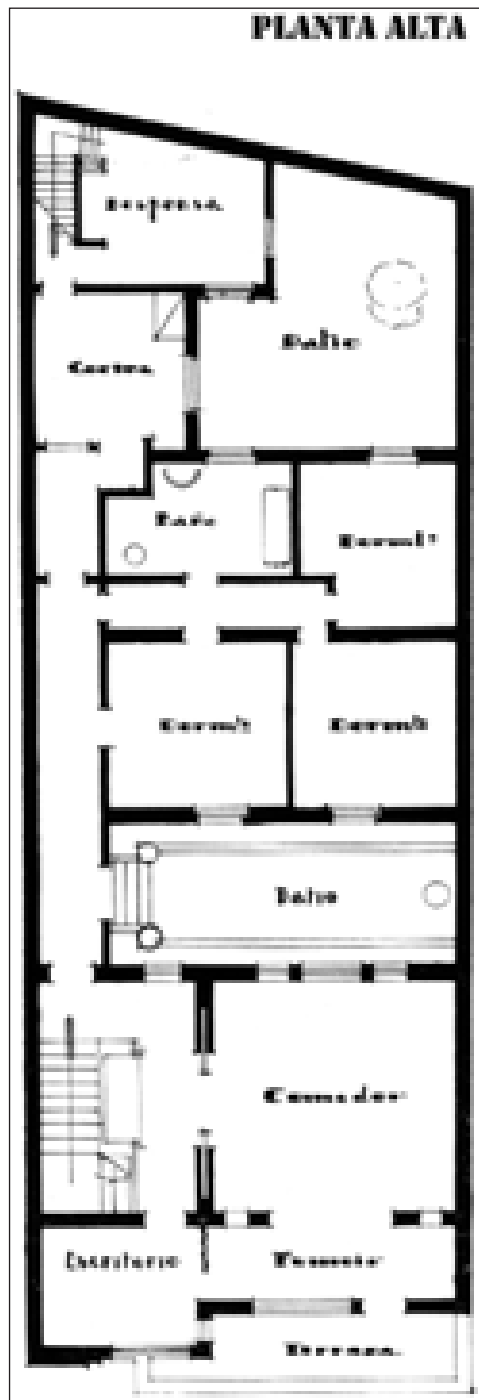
Vivienda Rocco, arquitecto J. A. Rius. Plano.
